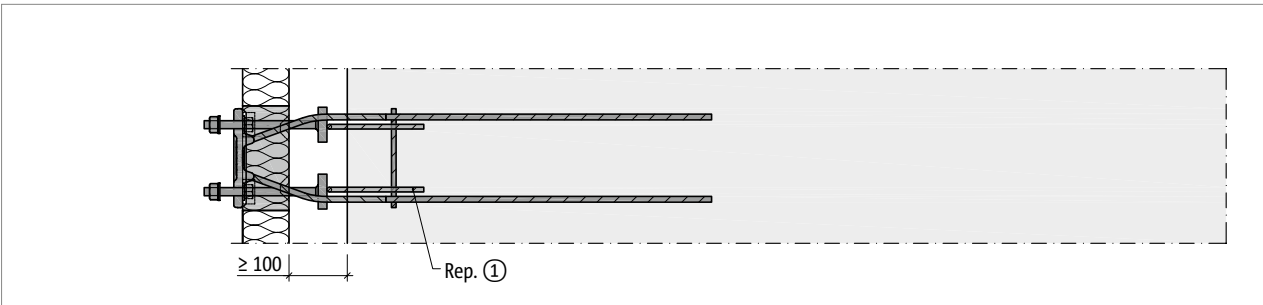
Schöck Isokorb® T type SQ : armatures à prévoir par le client dans le cas d'une construction en prédalle, vue en plan
